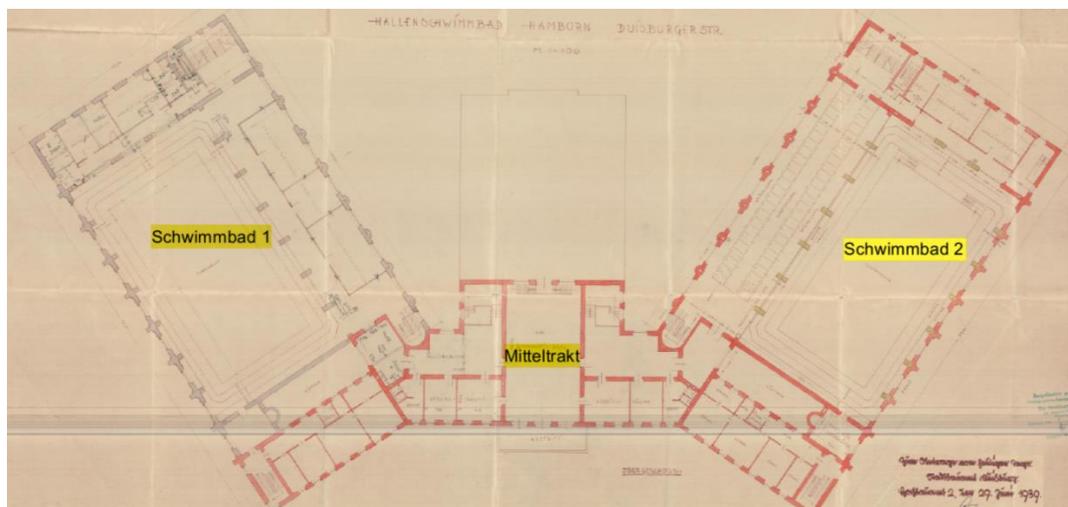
Grundriss Bestand [Traide Architekten]
